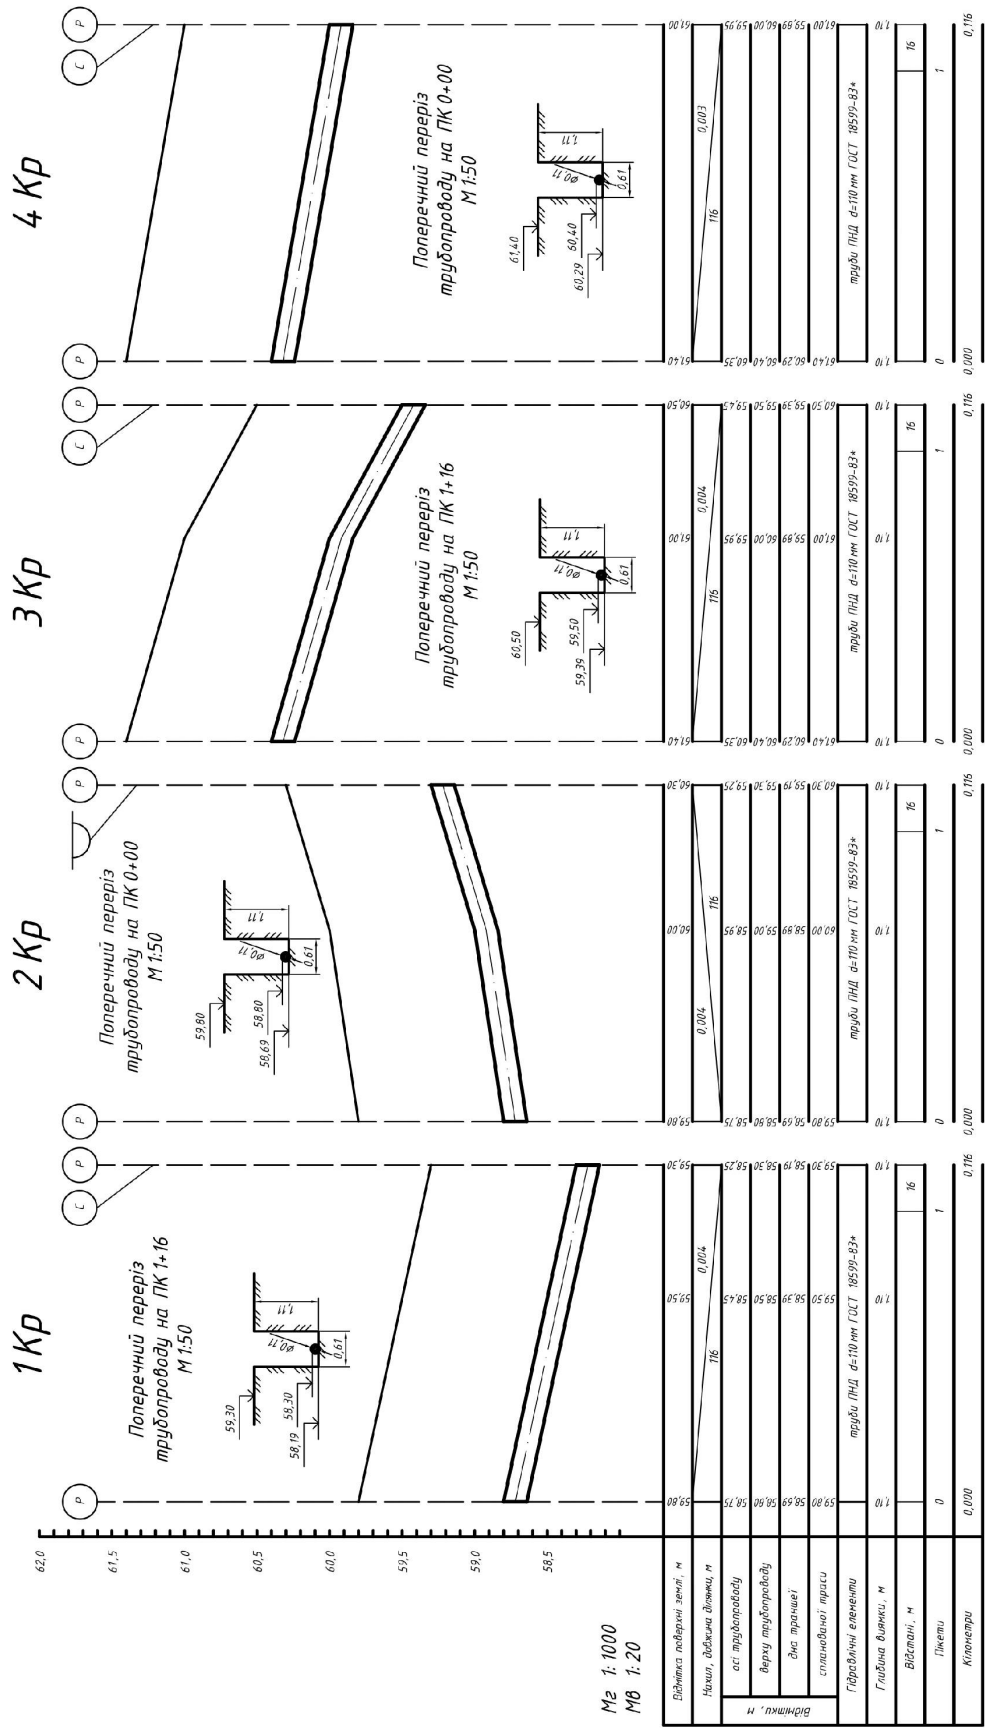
Поздовжні профілі зрошувальних трубопроводів
